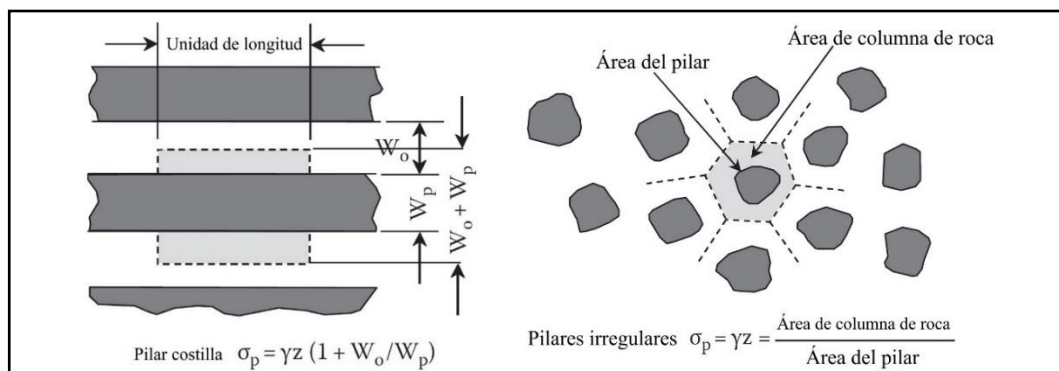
Promedio de la tensión vertical de los pilares en diseños típicos de pilares utilizando el método de área tributaria: vistas en planta
